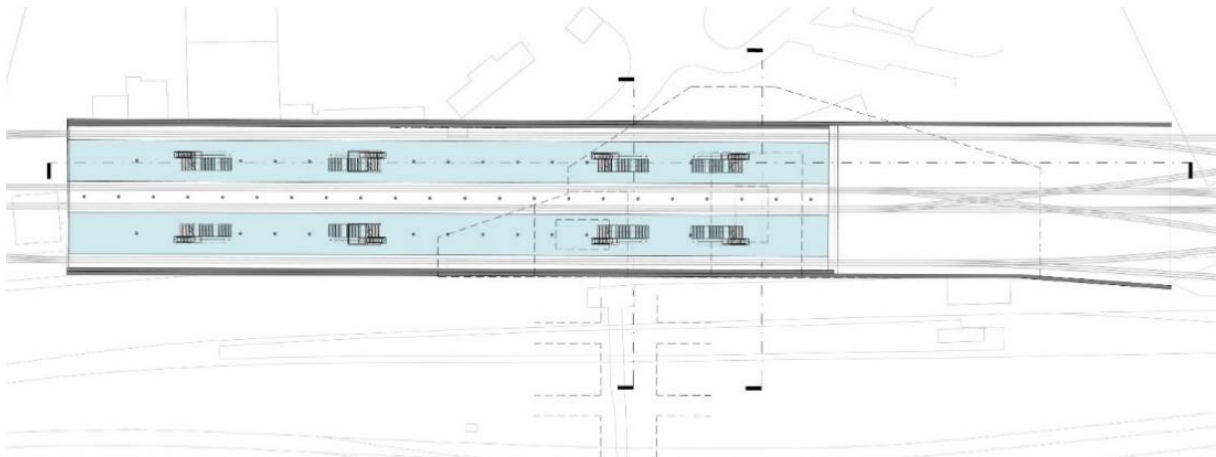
HP Altona Diebsteich IIIa - Grundriss Bahnsteigebene E-2
